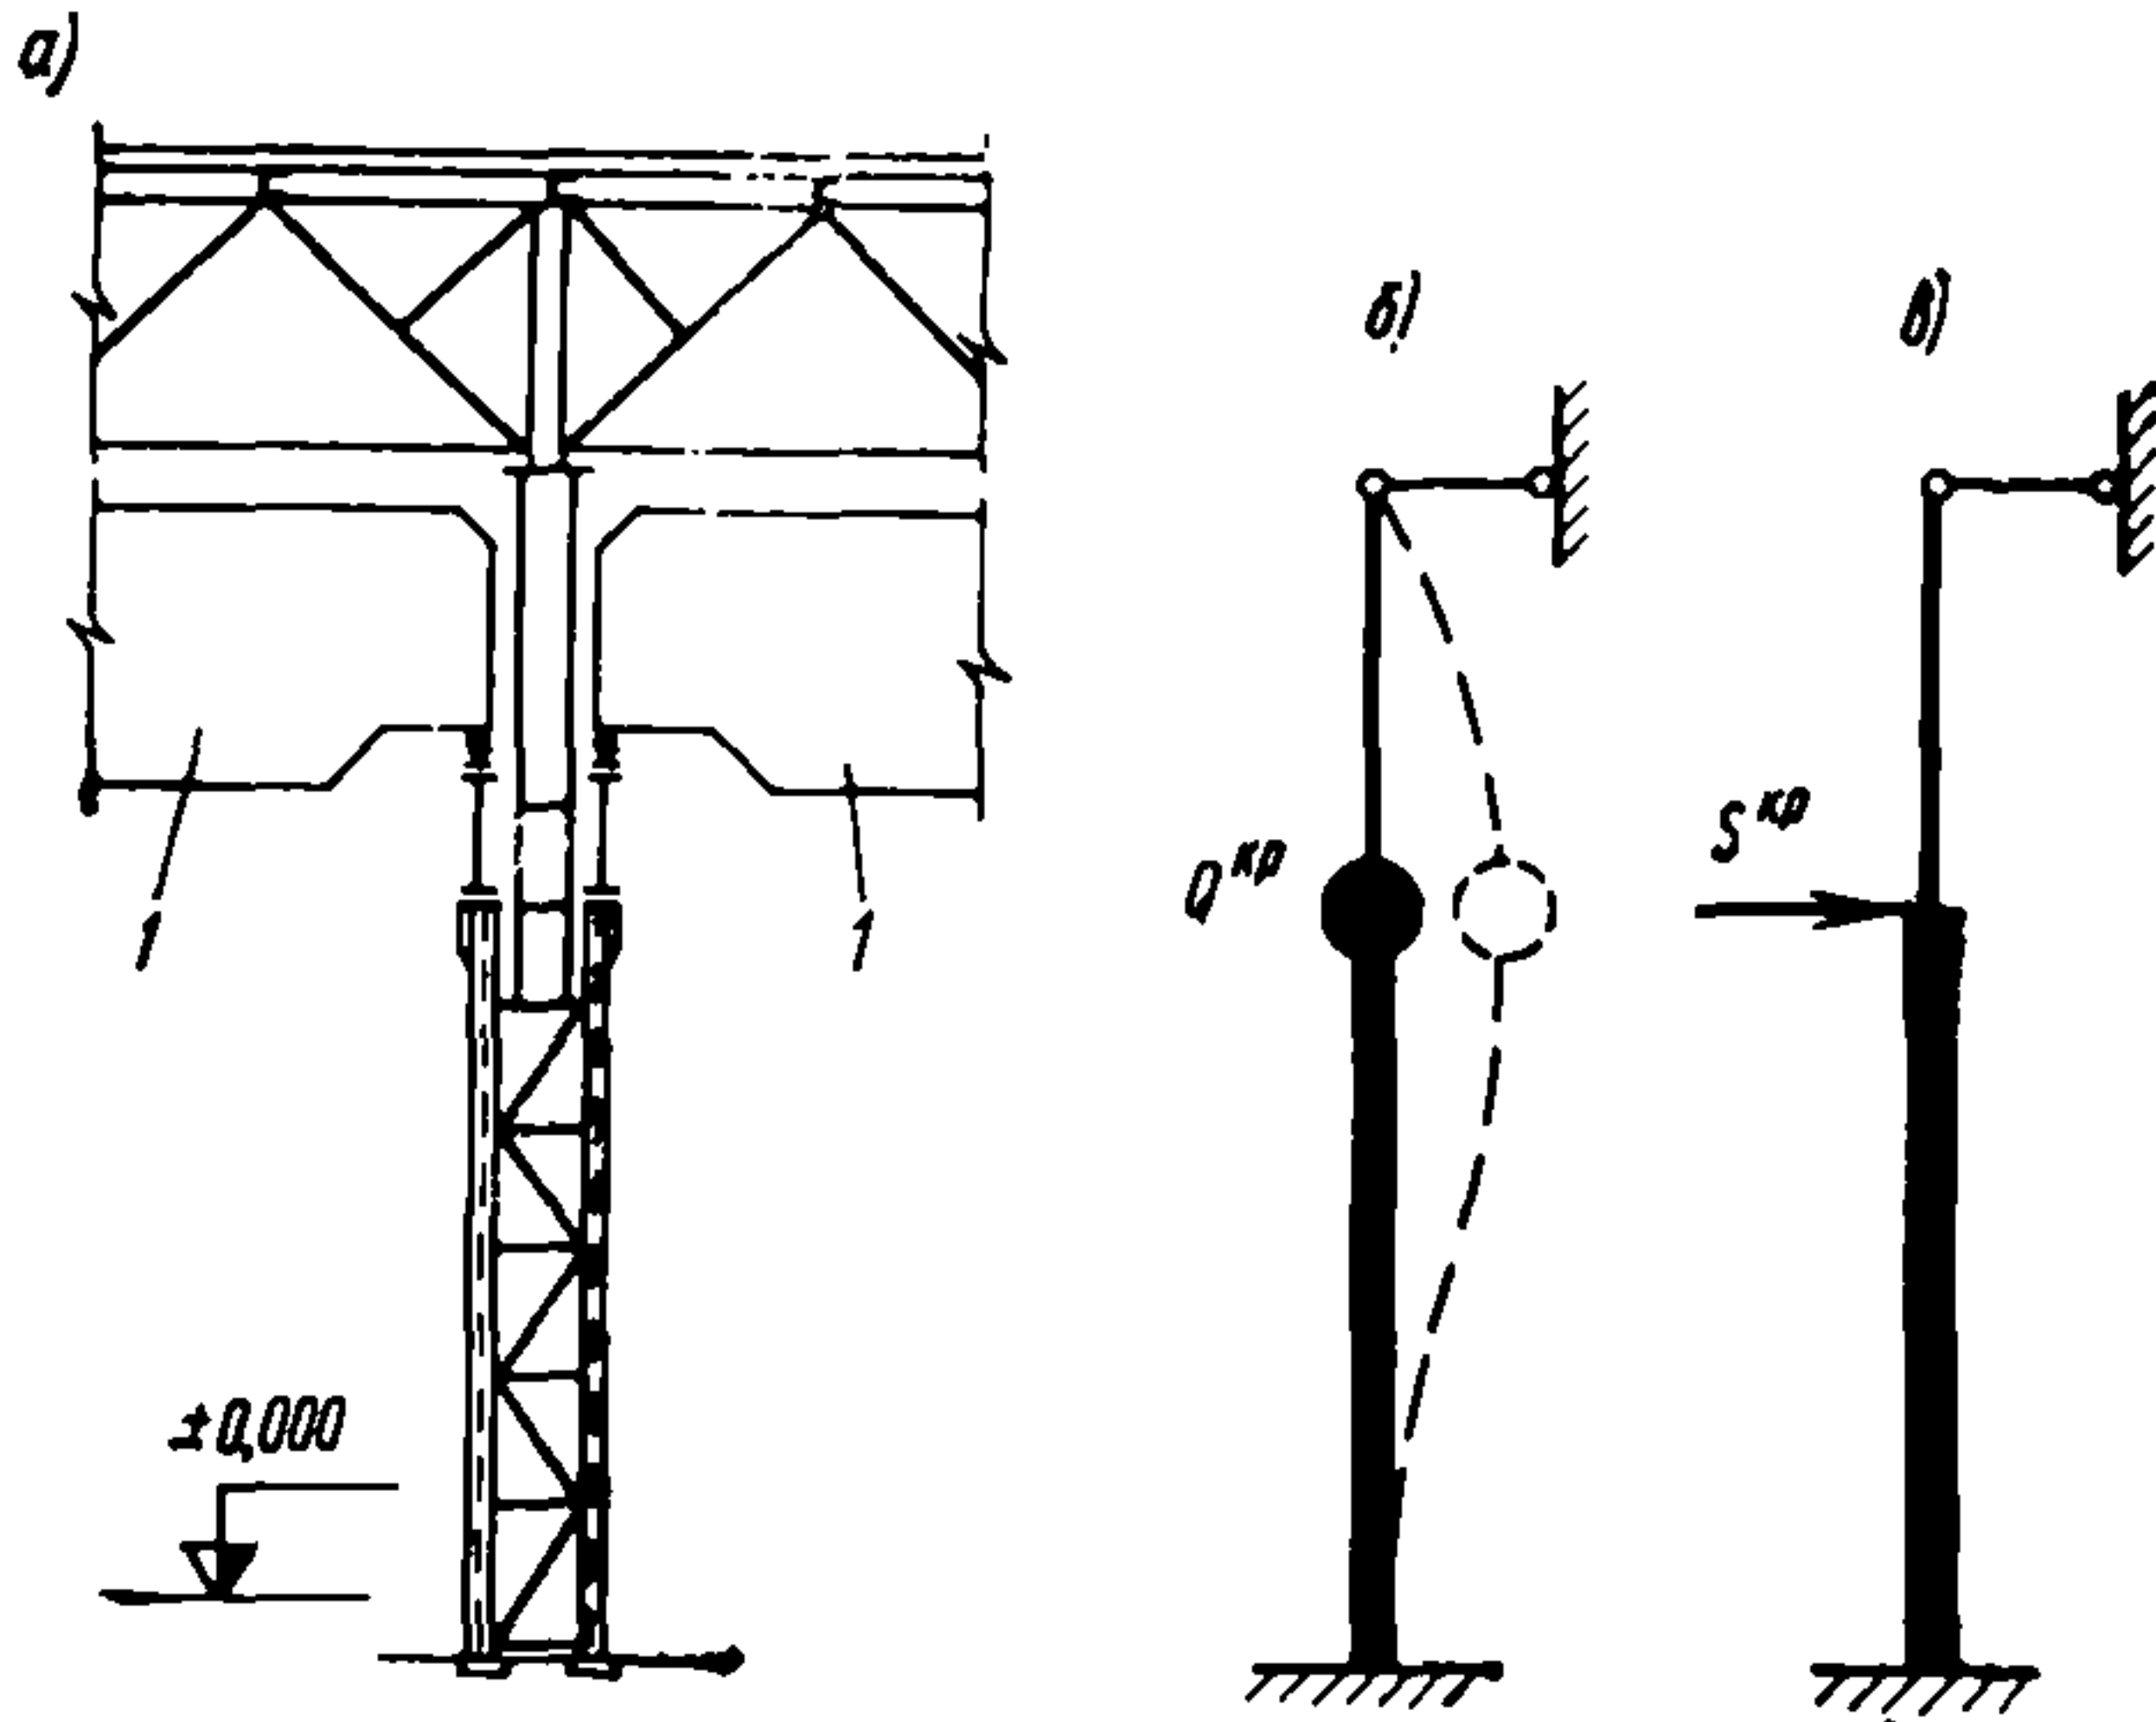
Схемы к расчету колонны на местную сейсмическую нагрузку от собственного веса моста крана
